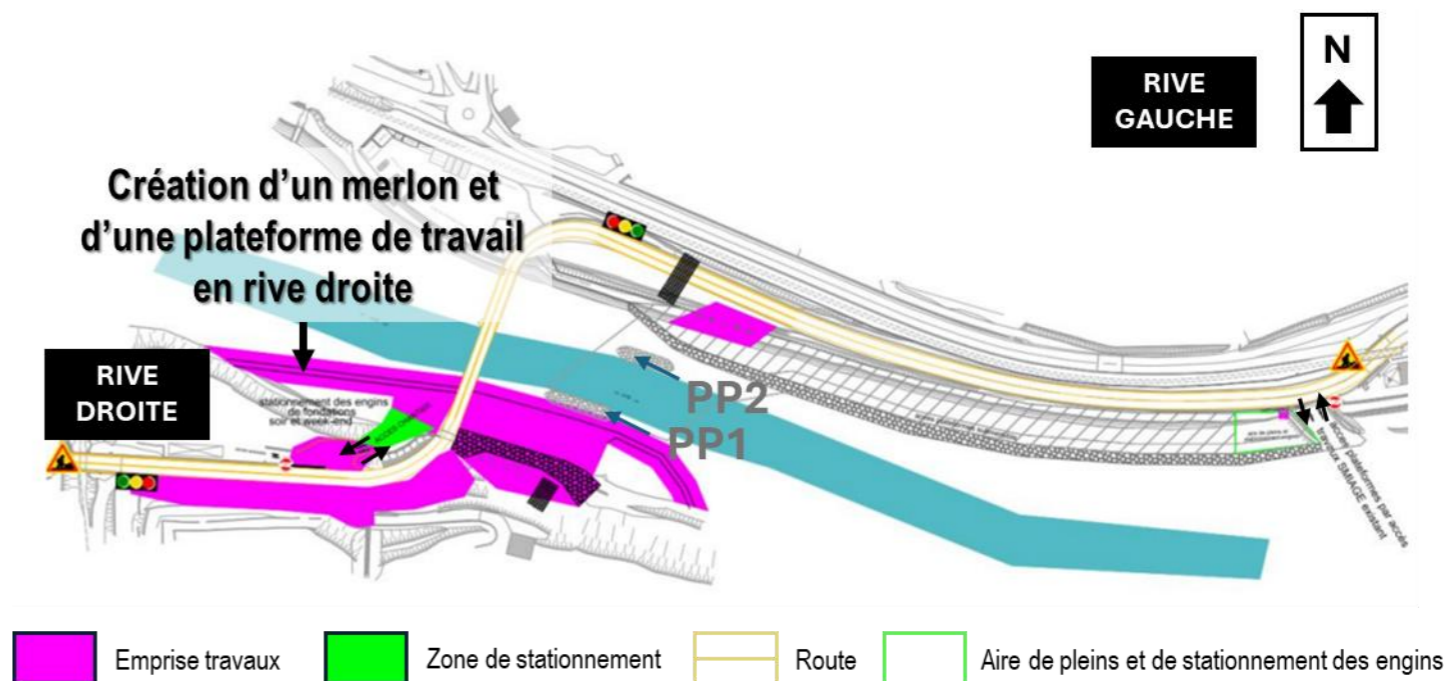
Dérivation du Var pour la construction du nouveau pont
